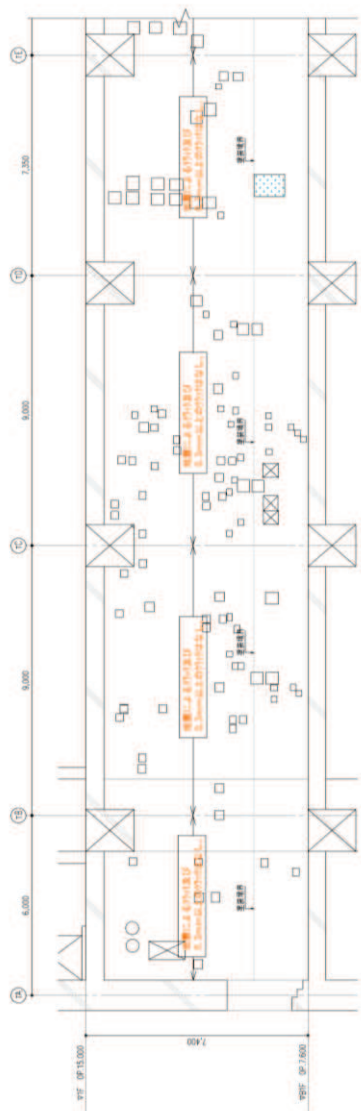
タービン建屋のひび割れ分布 耐震壁 (23) 地下 1 階 T7 通り
